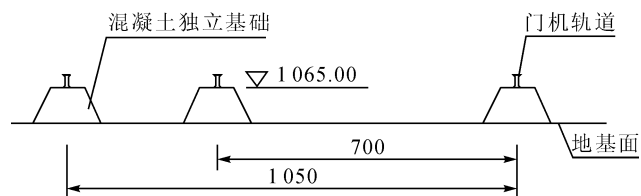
独立素混凝土门机轨道梁布置图(单位:cm)
